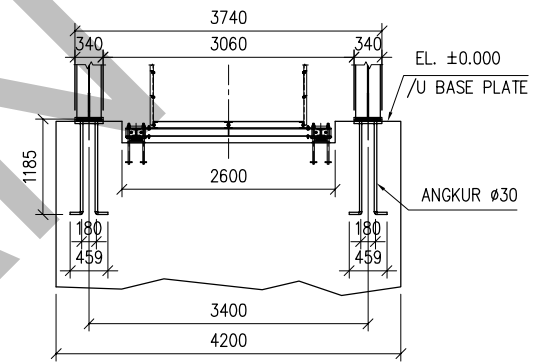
DETAIL DUDUKAN PILAR JEMBATAN GANTUNG BENTANG 120 m
